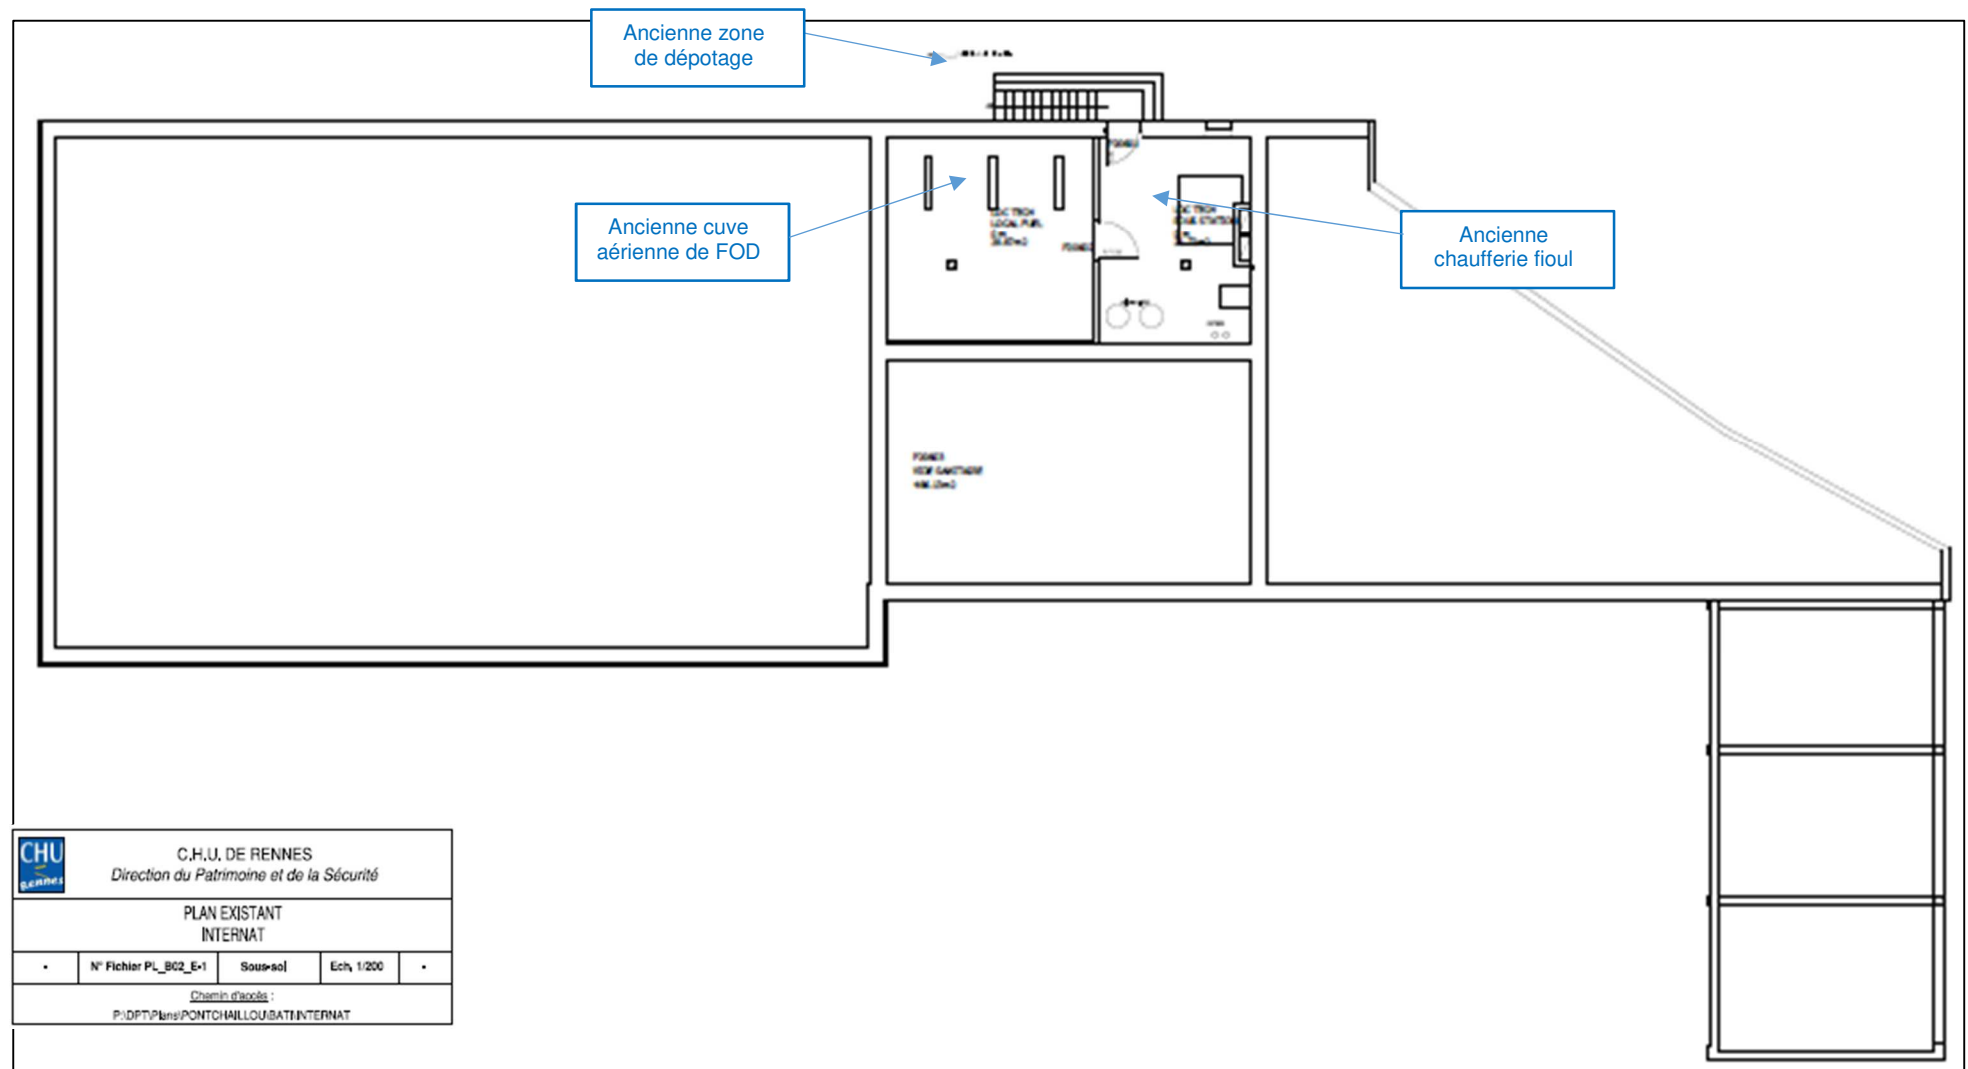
Plan de masse - Internat (sous-sol) (Source : CHU Pontchaillou)
